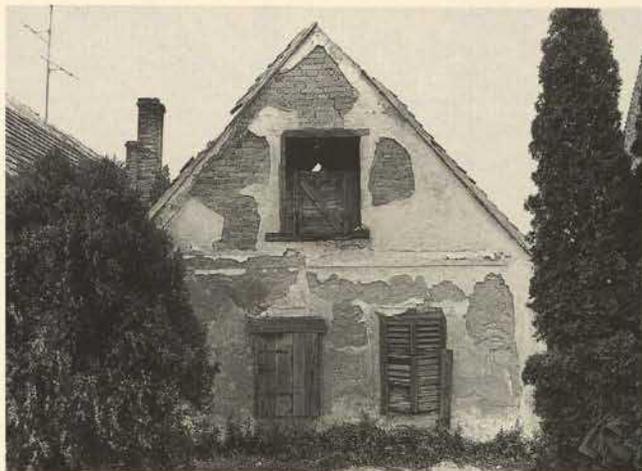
Hauptstraße 60, leerstehendes Nebengebäude im rückwärtigen Bereich des Anwesens, Giebelseite mit erheblichen Bauschäden.
